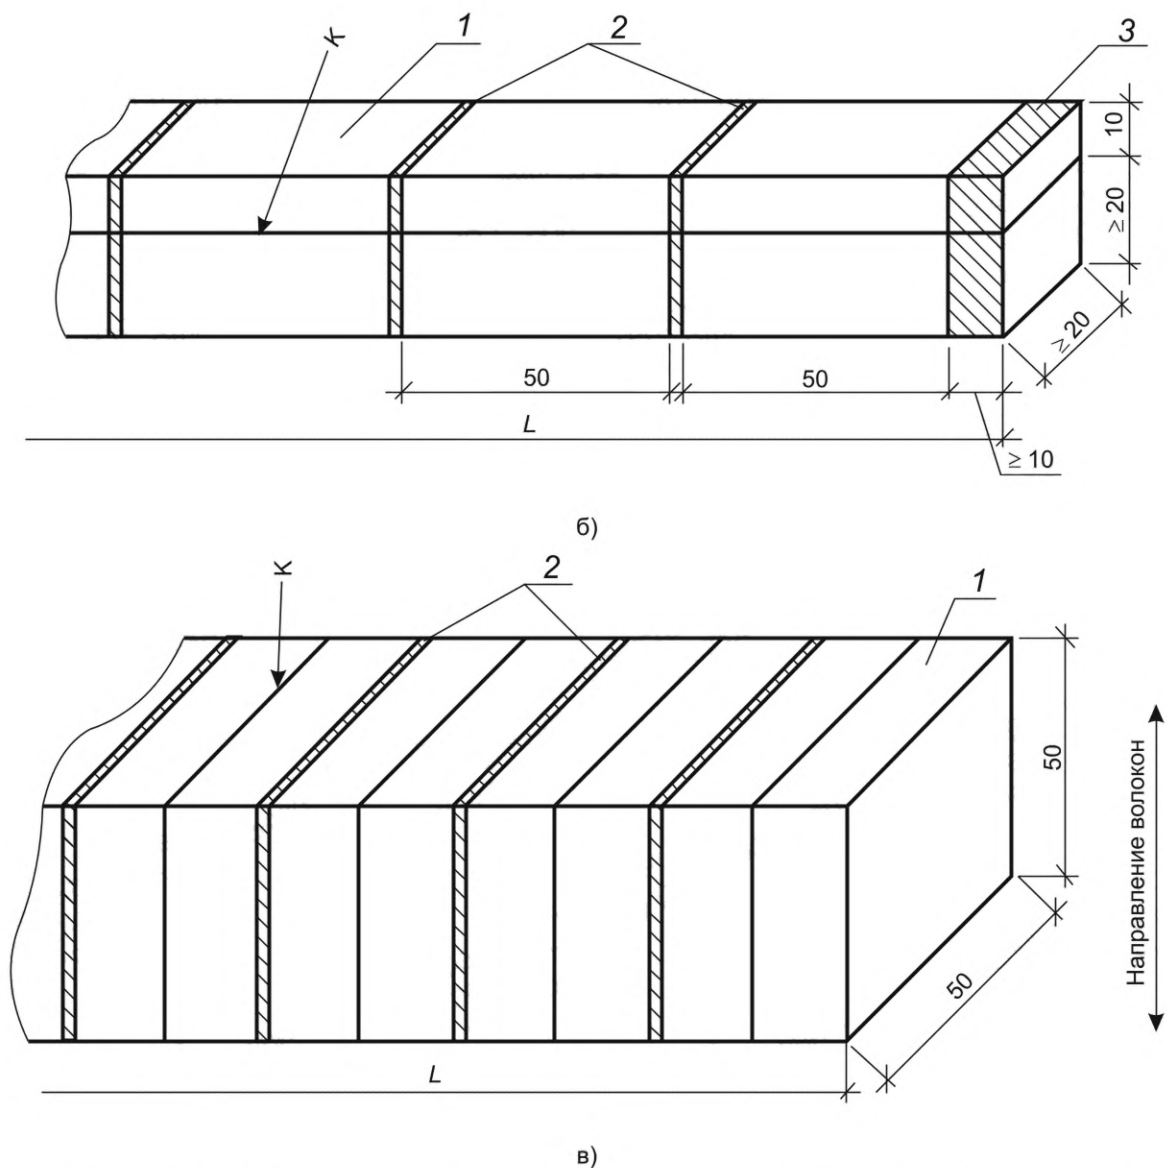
Форма и размеры образца для испытаний на скалывание
